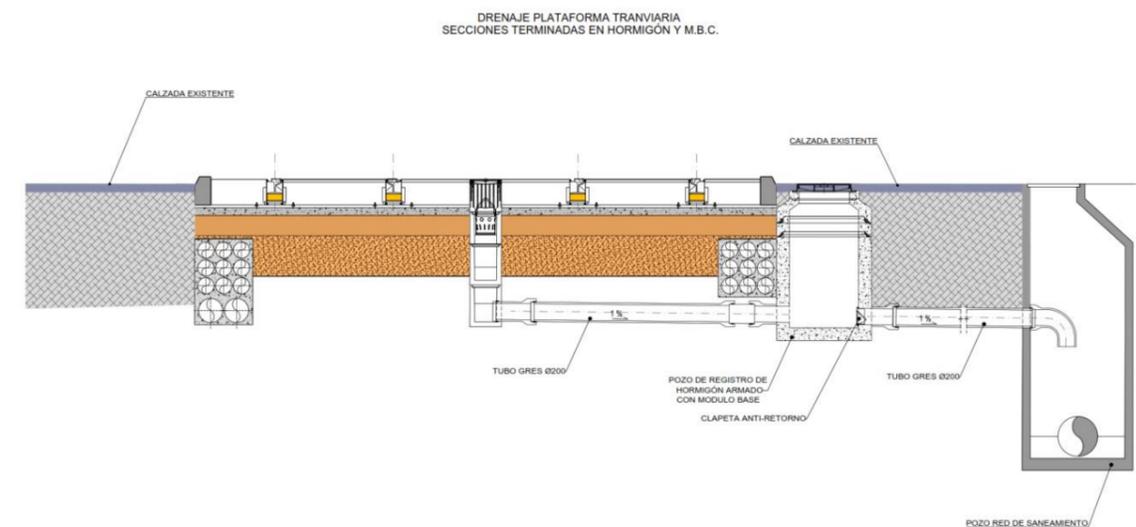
Sección tipo de drenaje en secciones con terminación en hormigón y M.B.C.
